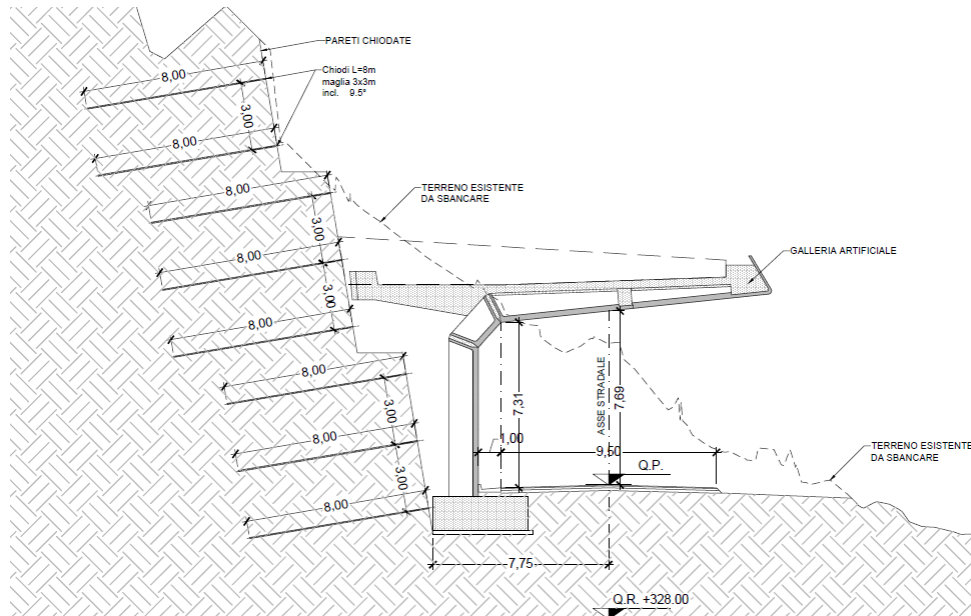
Sezione tipologica imbocco/sbocco galleria con struttura paramassi
